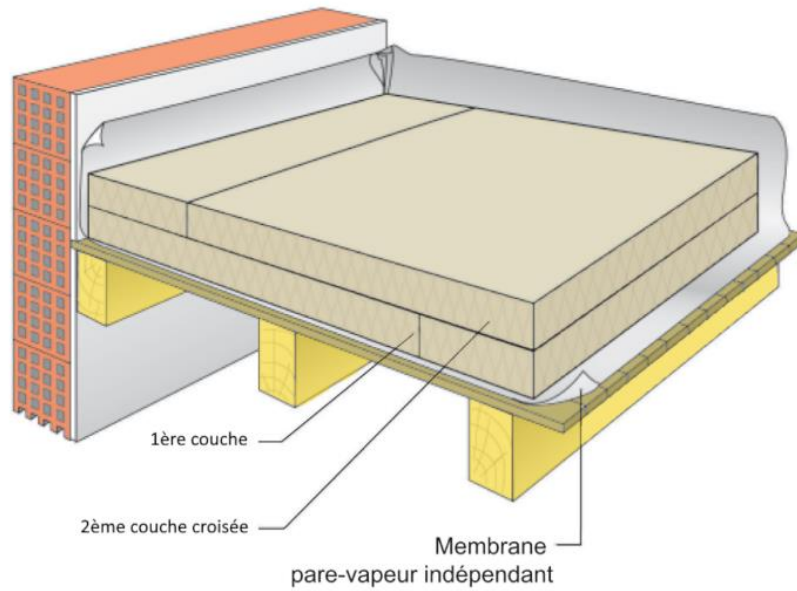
Mise en œuvre sur plancher de combles en 2 couches
